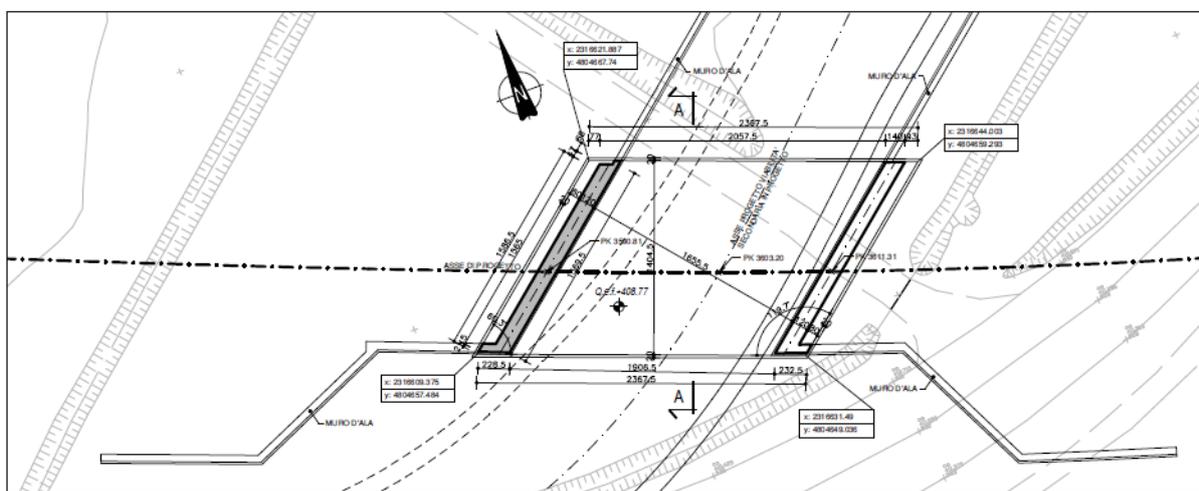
PLANIMETRIA SOTTOPASSO PK 3+603.18
